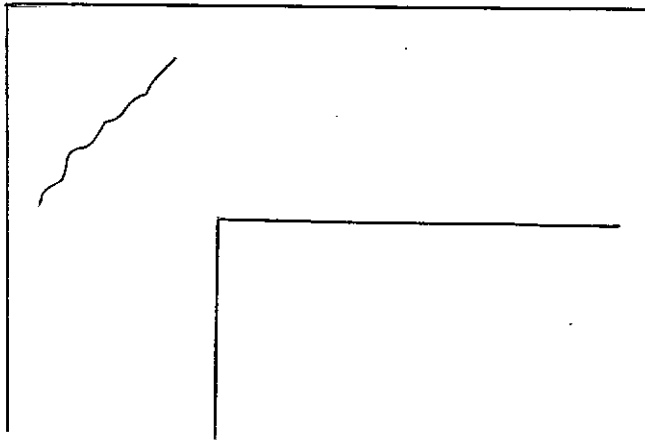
ESQUEMA DA FISSURA DIAGONAL
